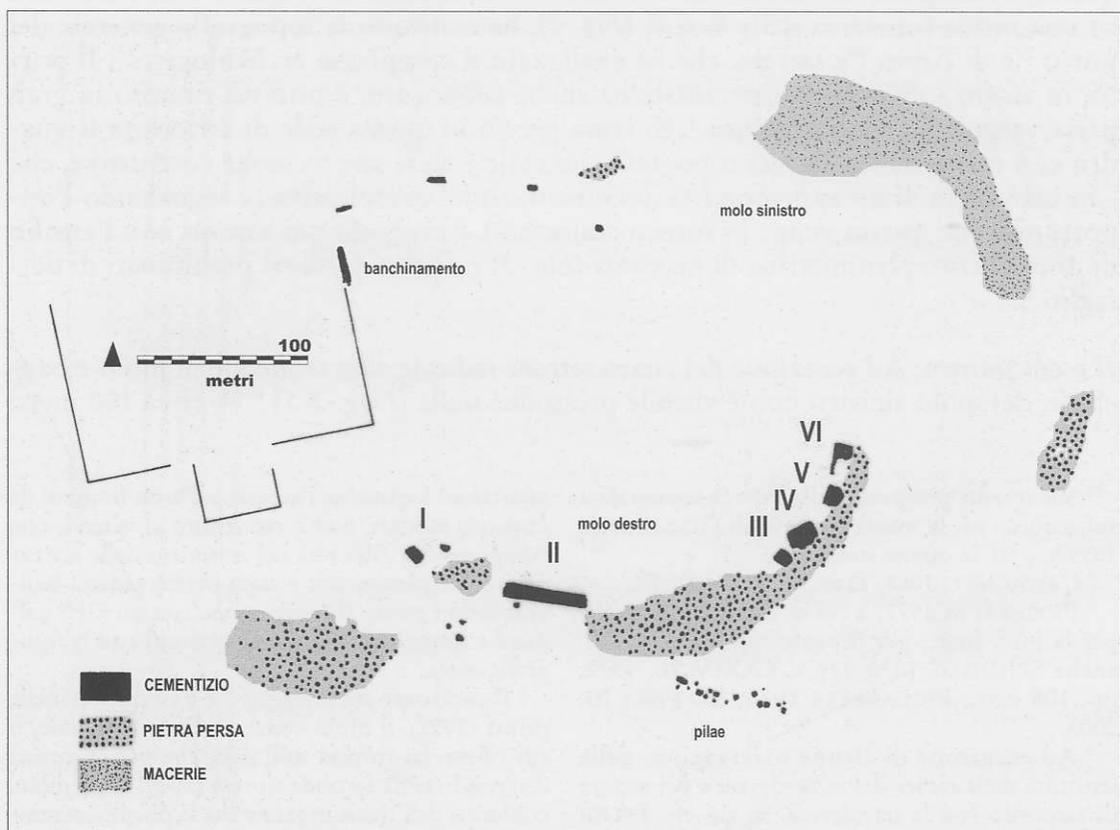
Astura, schizzo planimetrico interpretato dell'impianto portuale.
